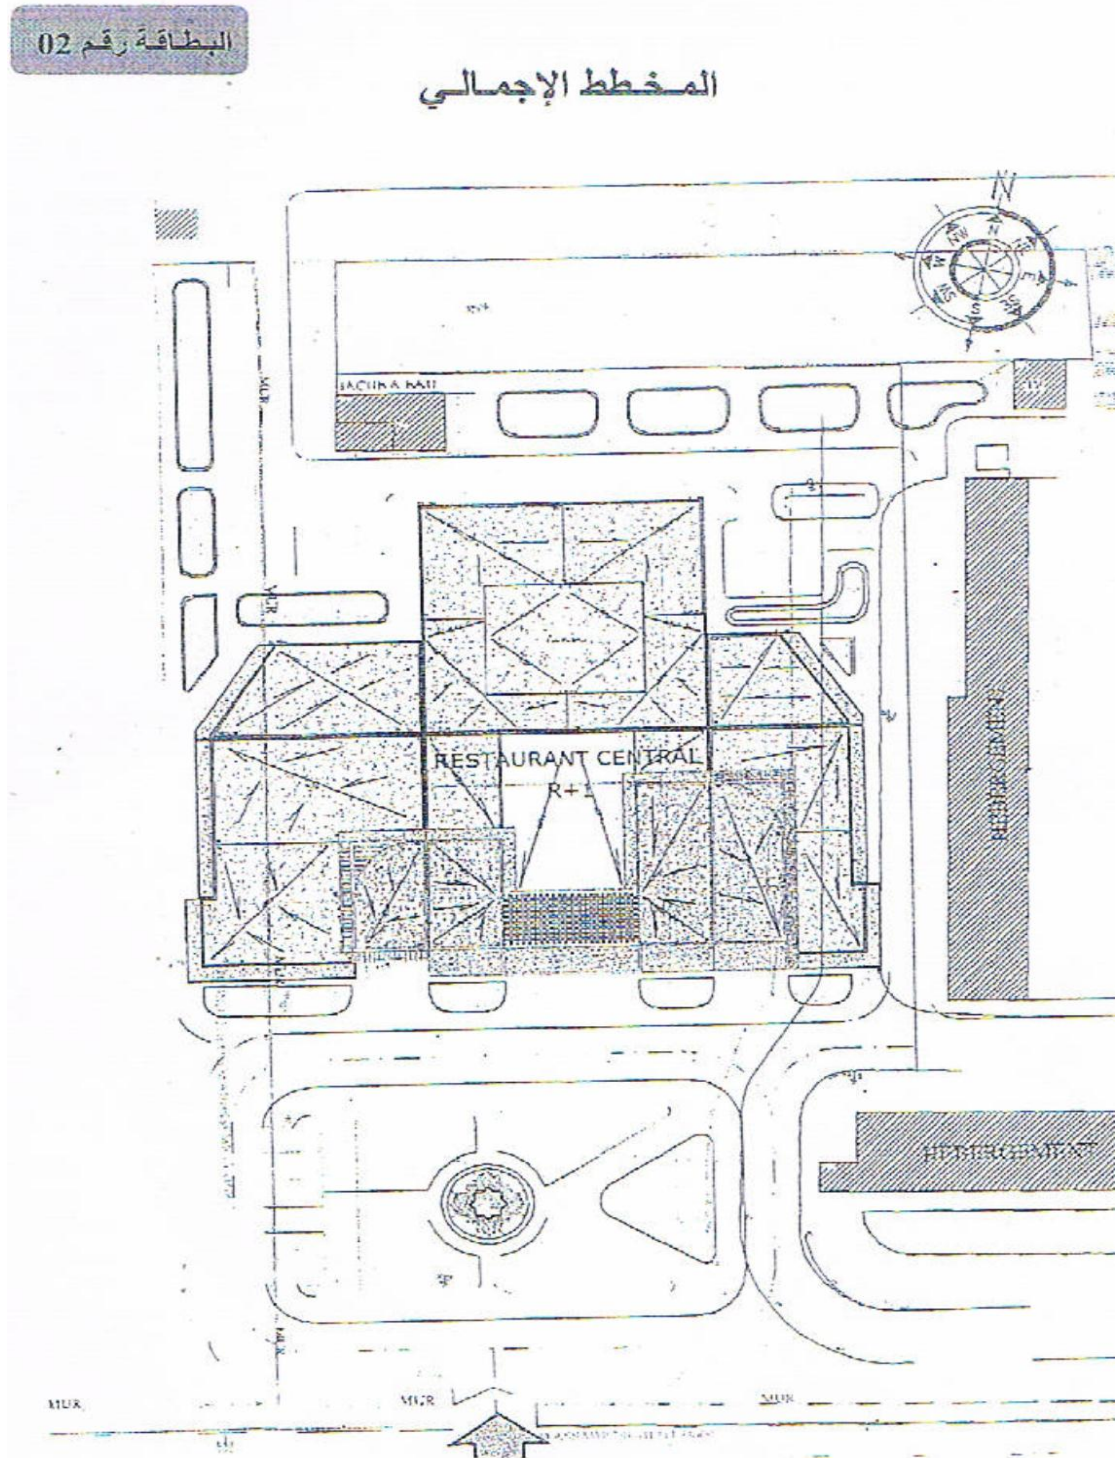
le plan total la restaurant central universitaire de la willaya de Laghouat
